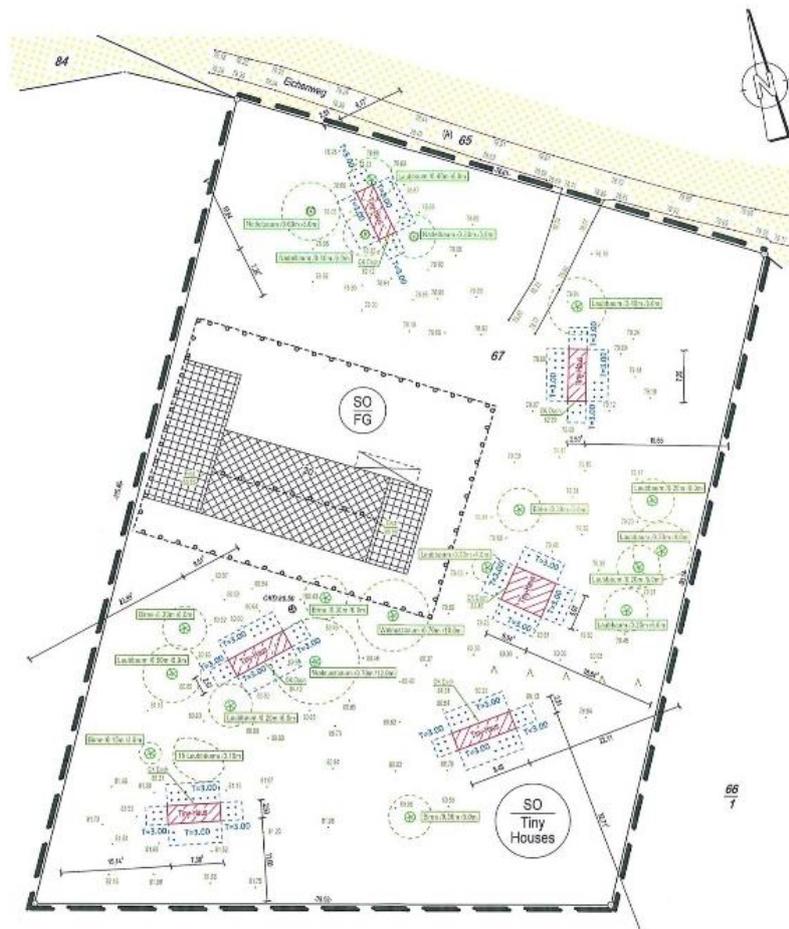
Auszug aus dem Bauantrag; Lage der Häuschen im amtlichen Lageplan
